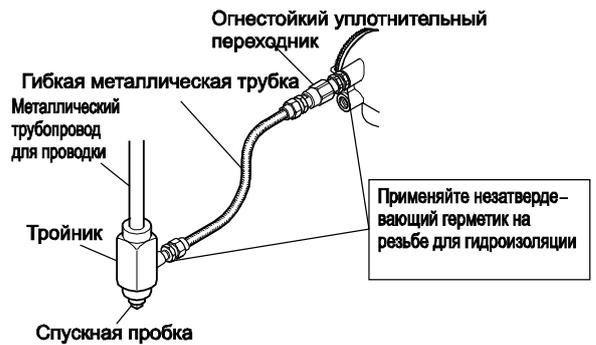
Типовая прокладка кабеля с использованием гибкой металлической трубки
